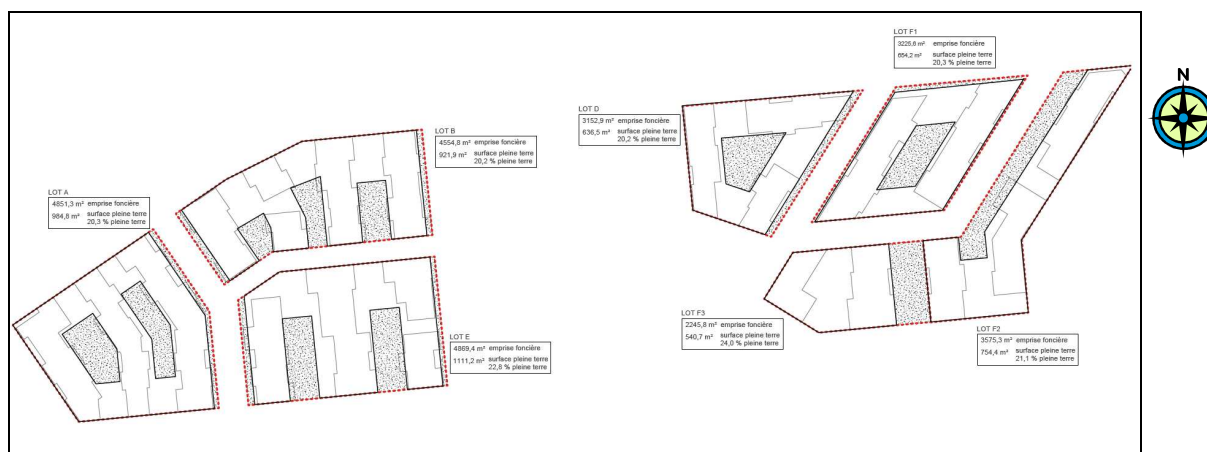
Plan d'emprise foncière et surface de pleine terre (SATHY)
